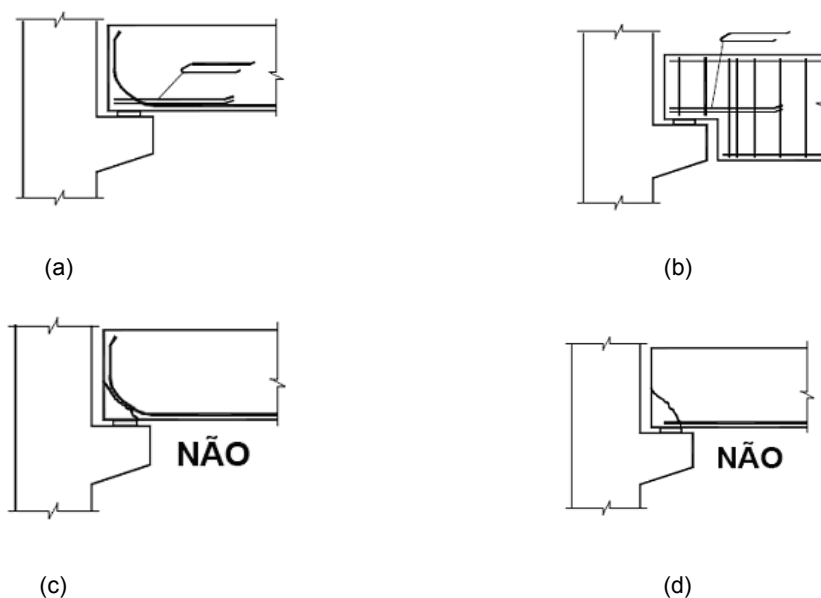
Pormenores tipo nas extremidades de vigas: a) laços como reforço na zona do apoio; b) laços em vigas com dente; c) rotura em pormenor errado ou excesso de recobrimento; d) rotura por falta de amarração da armadura (extraída de [3])
